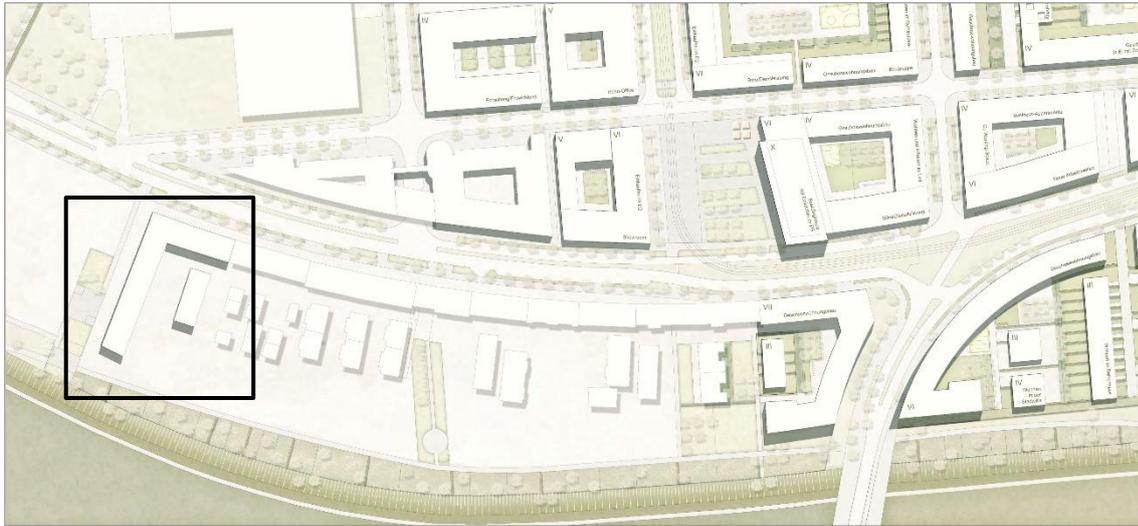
Masterplan (Werkstattverfahrens 2012) mit Markierung des Bebauungsplangebietes
